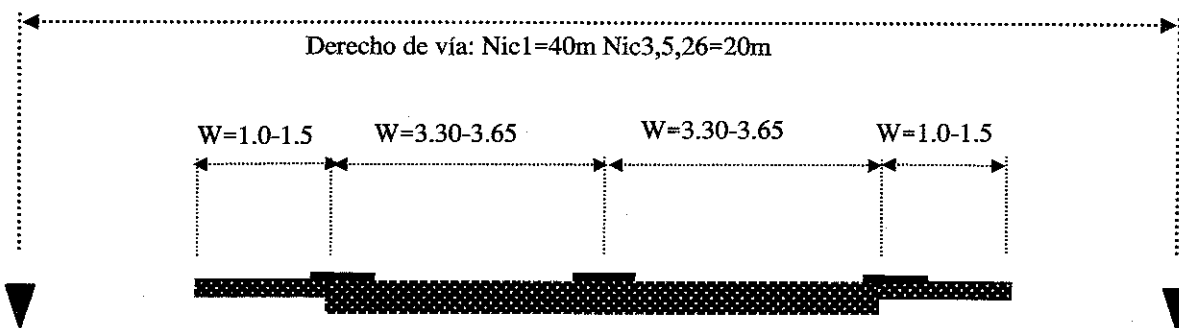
Típica sección transversal estándar y Derecho de vía
